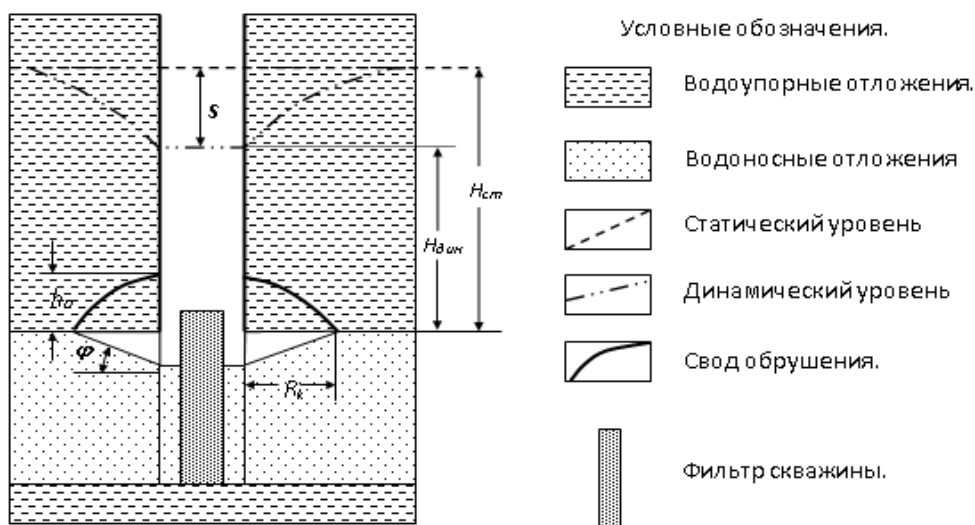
Схема для расчета устойчивости кровли скважины 7-РЭ
